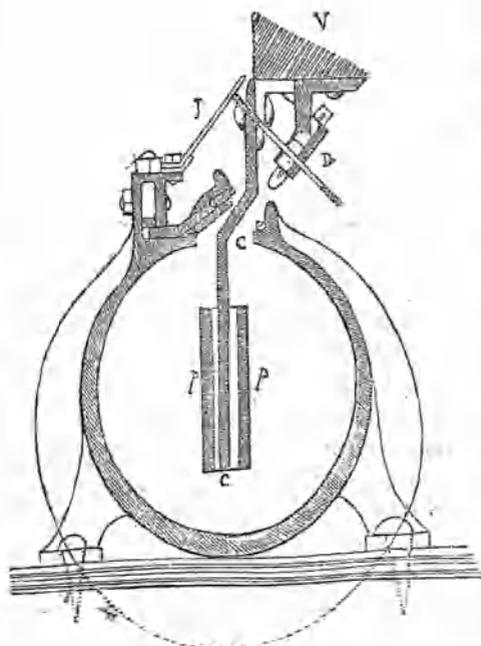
º Seccion transversal en el tubo, durante el paso de la espiga metálica.
